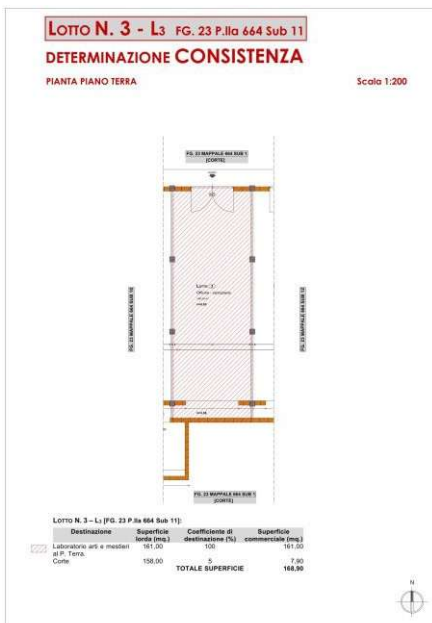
Determinazione consistenza Lotto L₃ (ALL. 11).
